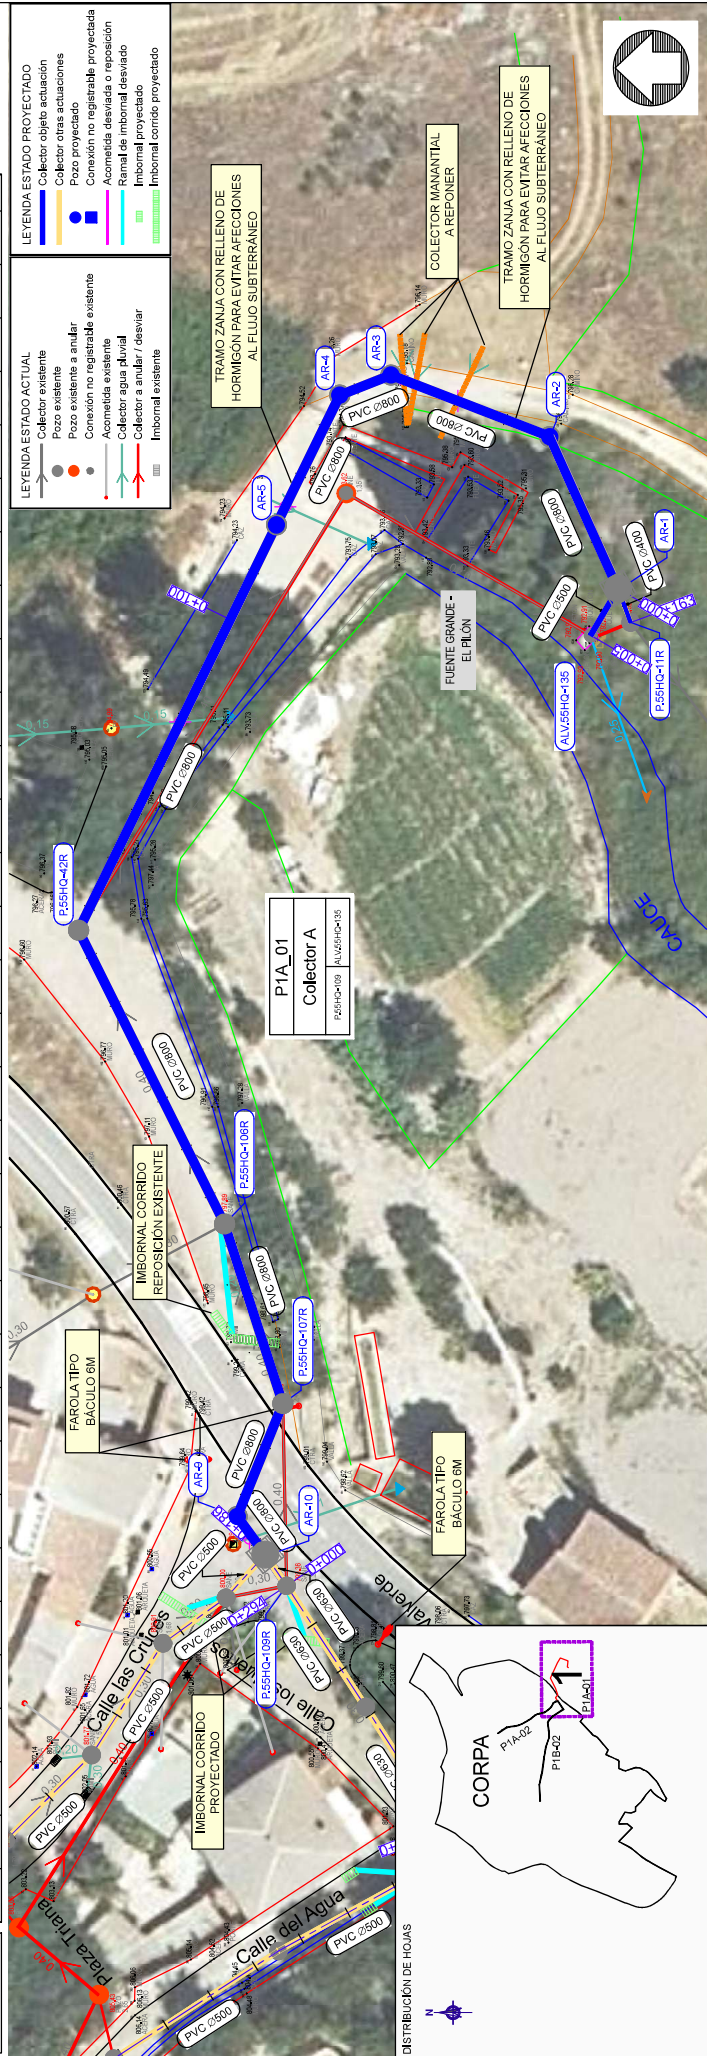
Planta de las actuaciones proyectadas.
